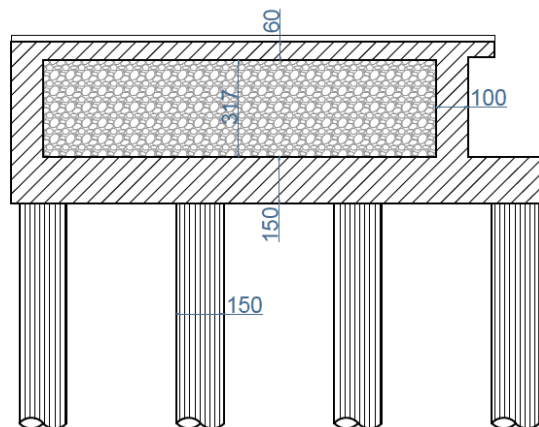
sezione verticale spalla zavorrata, quotata in cm
